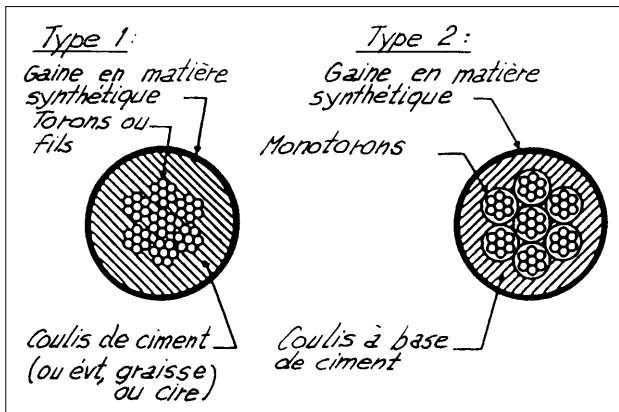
Forme de la section de câbles extérieurs (VSL, 1988).
